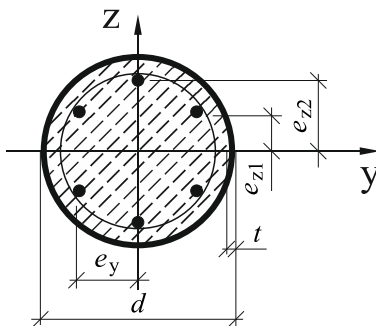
Поперечное сечение сталежелезобетонной колонны круглого сечения
